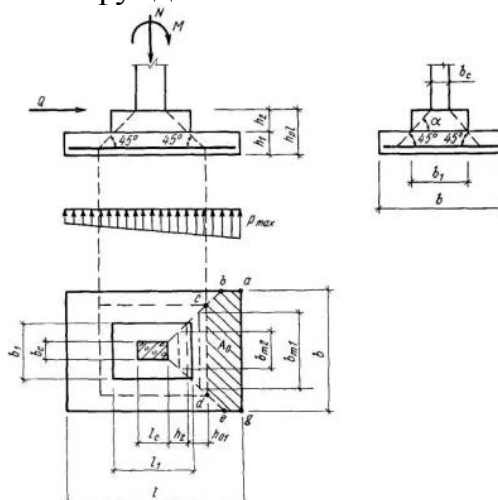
Схема образования пирамиды продавливания в центрально-нагруженных прямоугольных, а также внецентренно нагруженных квадратных и прямоугольных фундаментах
